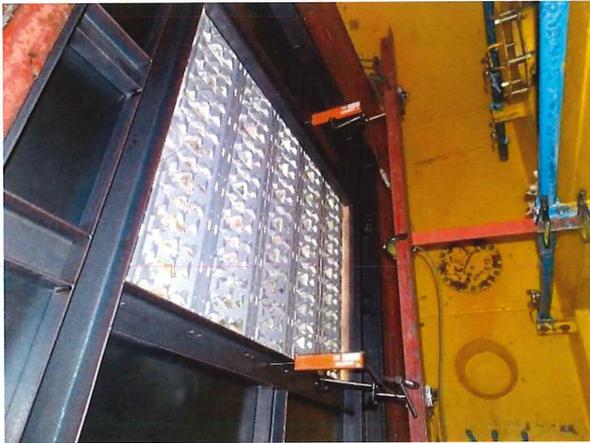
変位計設置状況 (試験体 No.1 : 屋内側)
